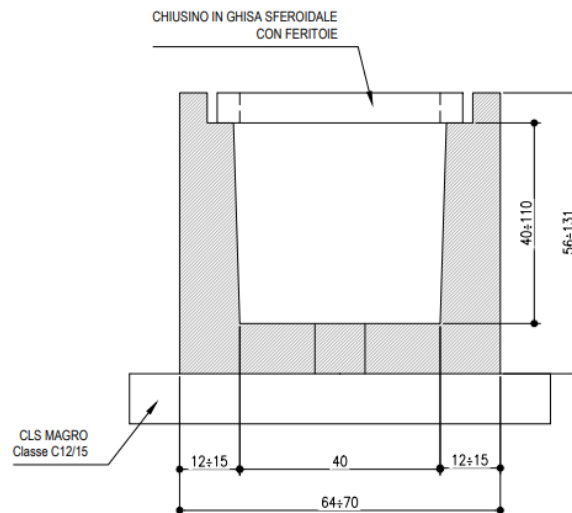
Sezione tipologica della canaletta a sezione rettangolare in cls
